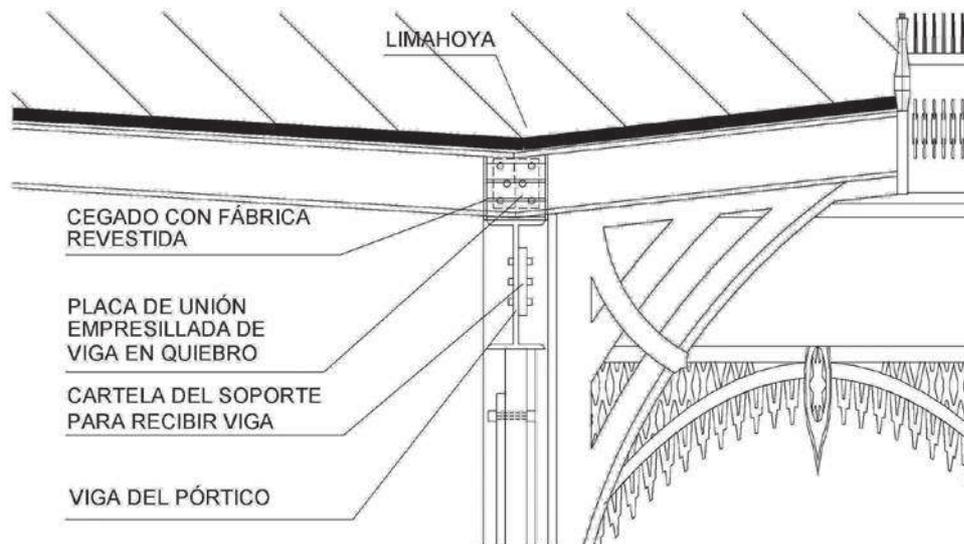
Detalle constructivo de la ménsula de cubierta.
